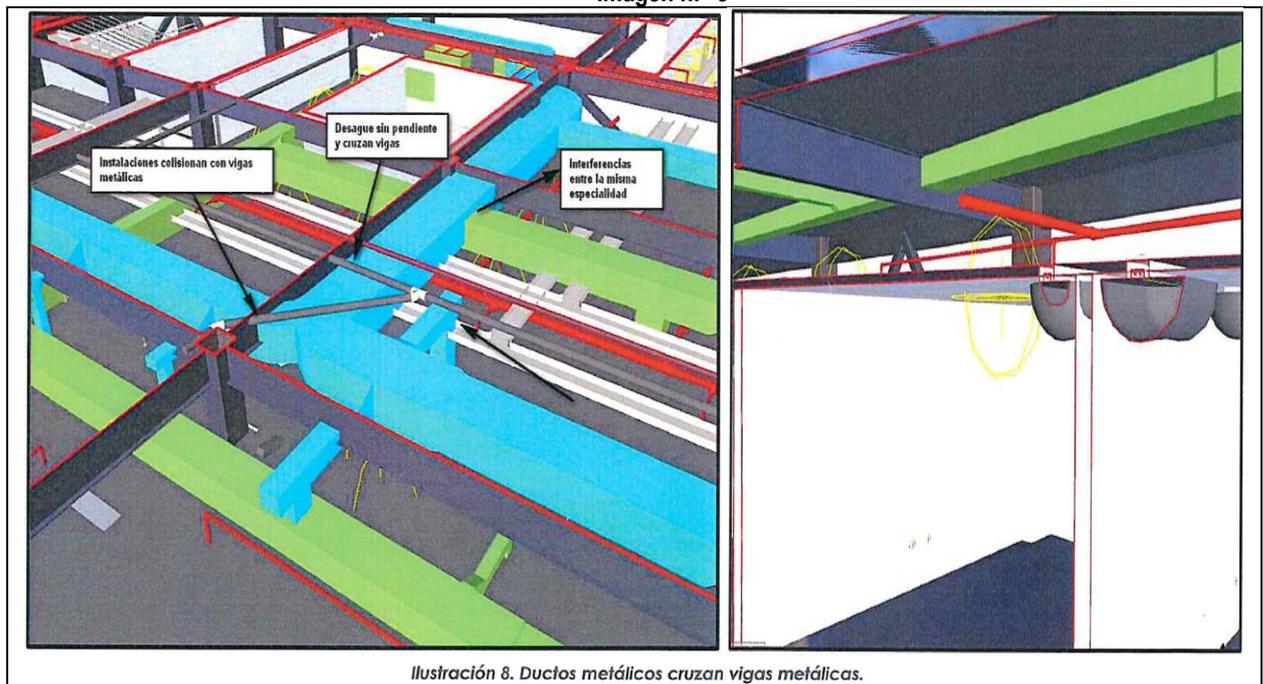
Ductos metálicos cruzan vigas metálicas.
